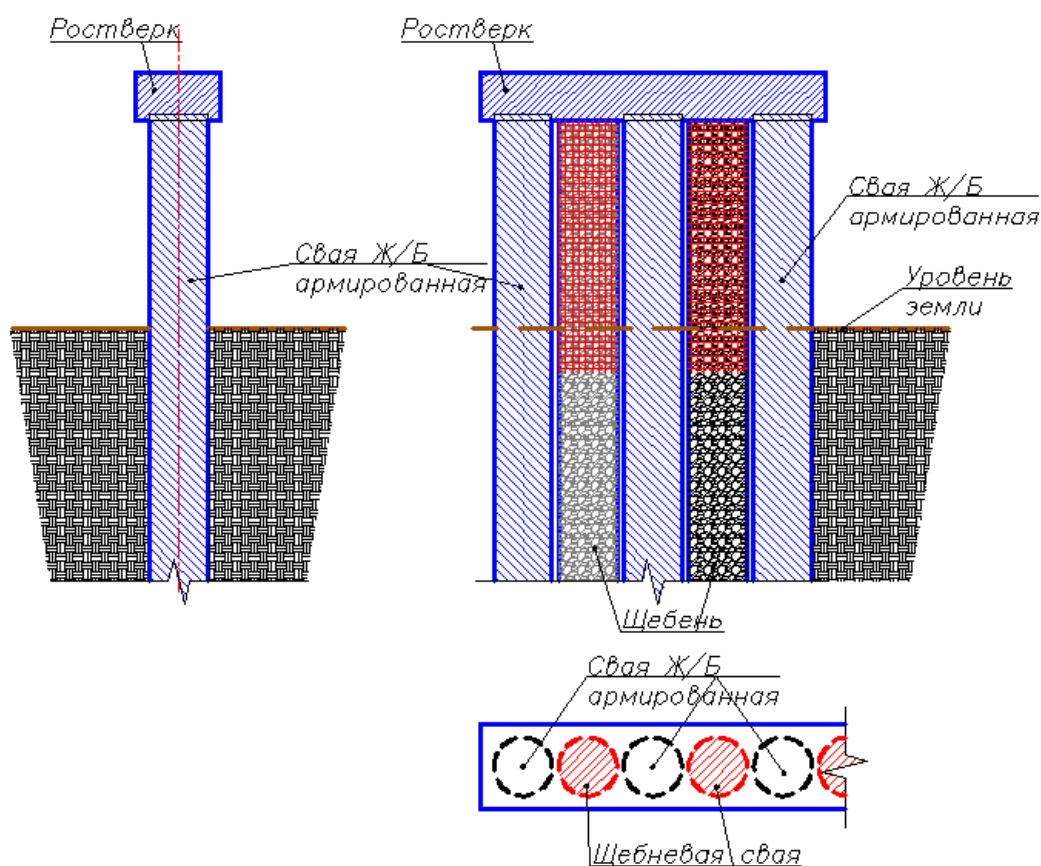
Железобетонная подпорная стенка на свайном основании
